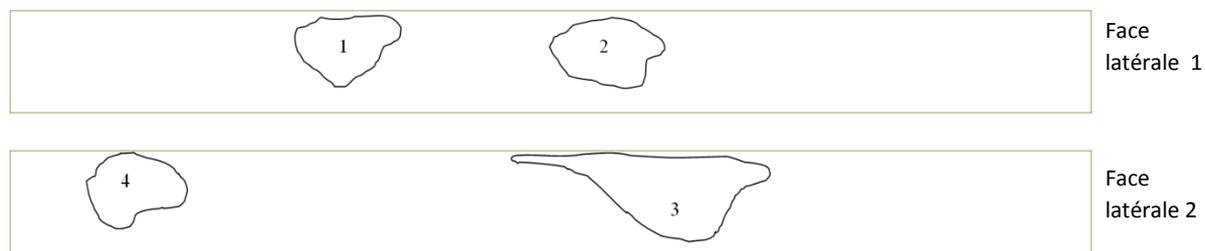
Localisation des désordres relevés sur les faces latérales de la poutre au cours de l'essai.
